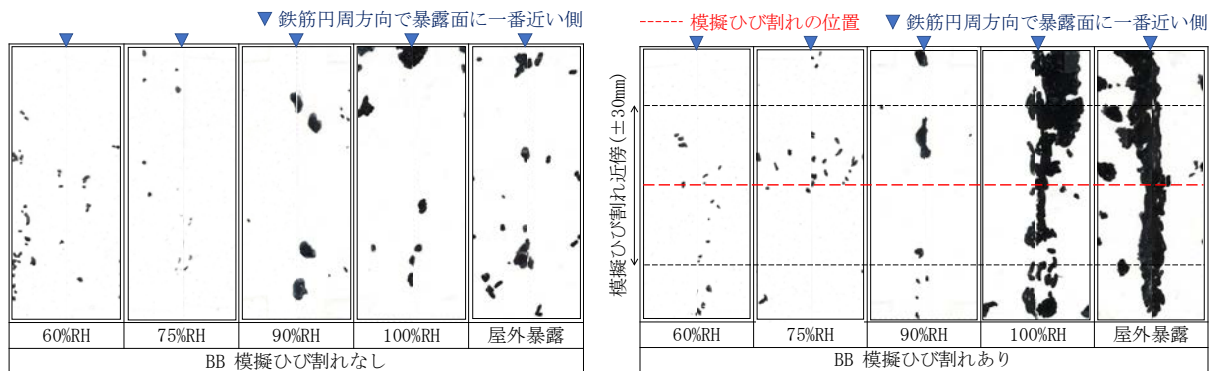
暴露試験終了時の鉄筋表面の鉄筋腐食箇所のトレース結果 (BB/模擬ひび割れなし, あり)
